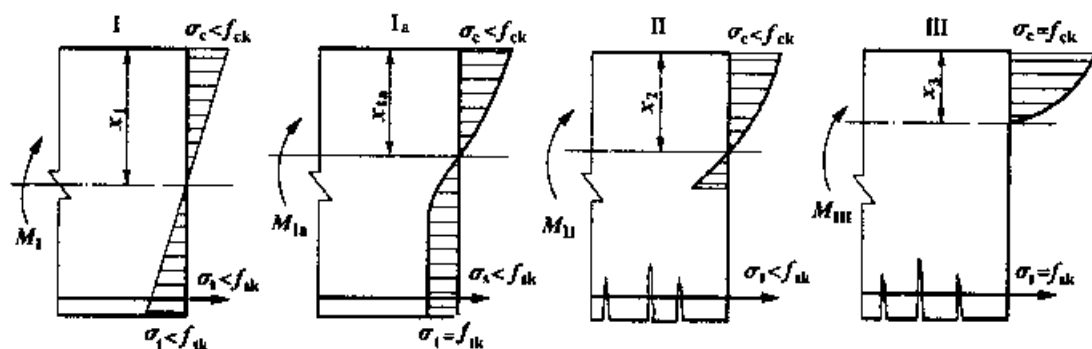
钢筋混凝土梁各受力阶段截面应力分布情况
